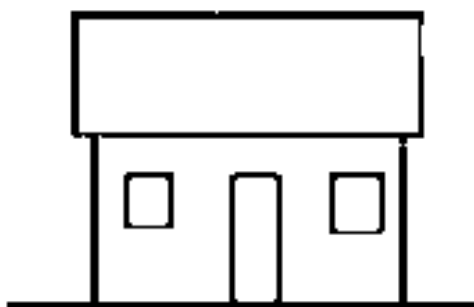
Esboço da planta- baixa e plano marginal em Natividade.
